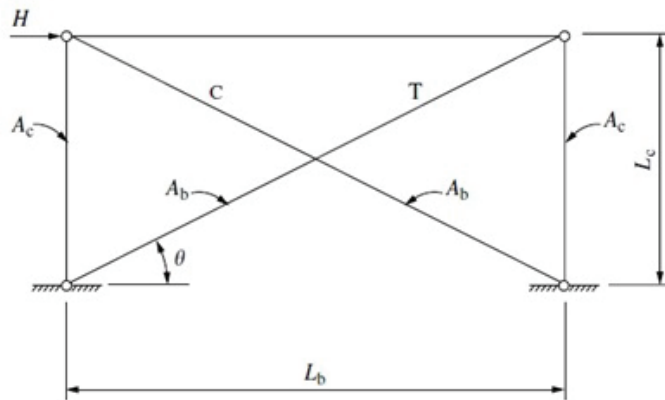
Sistema de contraventamento diagonal aplicado a um pórtico simples [16].
